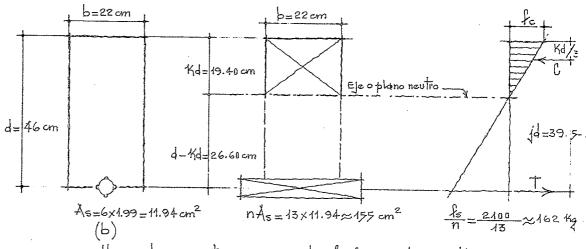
b. Corte transversal de la viga. Fig. 3.24. Årea transformodo de la sección. Fig. 3.25. Diagramo de fatigas. Haciendo momentos con vespecto al plano nentro, se tiene:
